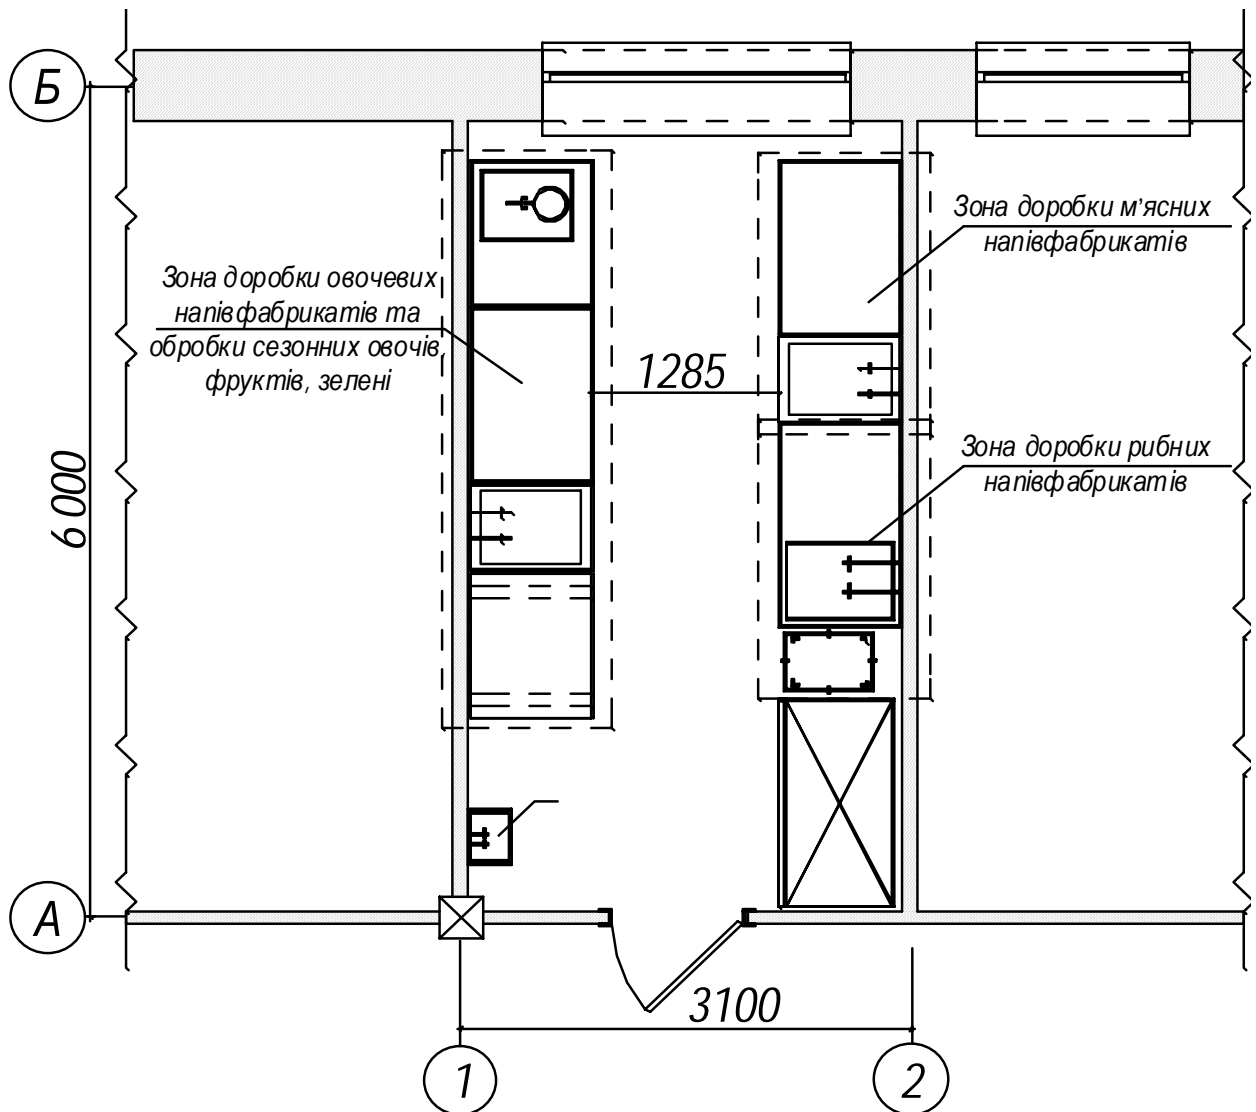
Компоновочне креслення доготовочного цеху з розстановкою обладнання
